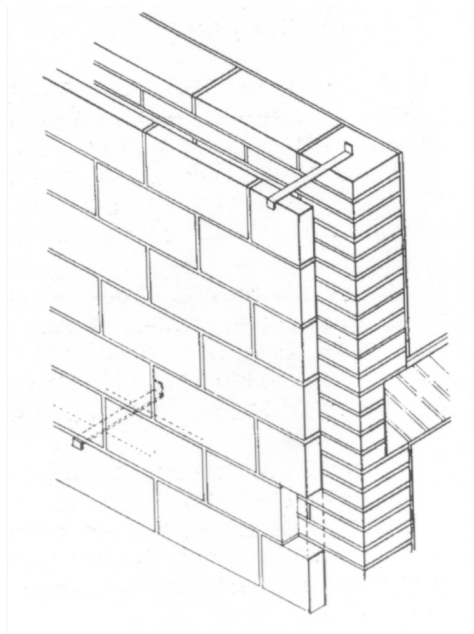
Grabado de la construcción moderna de Warland, publicado en España en 1947. Cavity Wall inglés.
